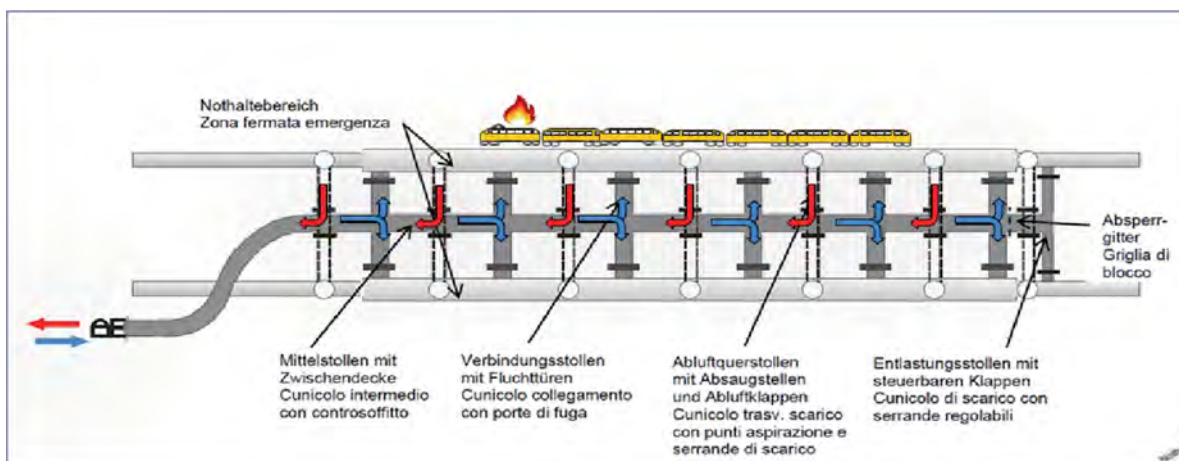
Layout area di sicurezza e schematizzazione della ventilazione in caso di incendio
